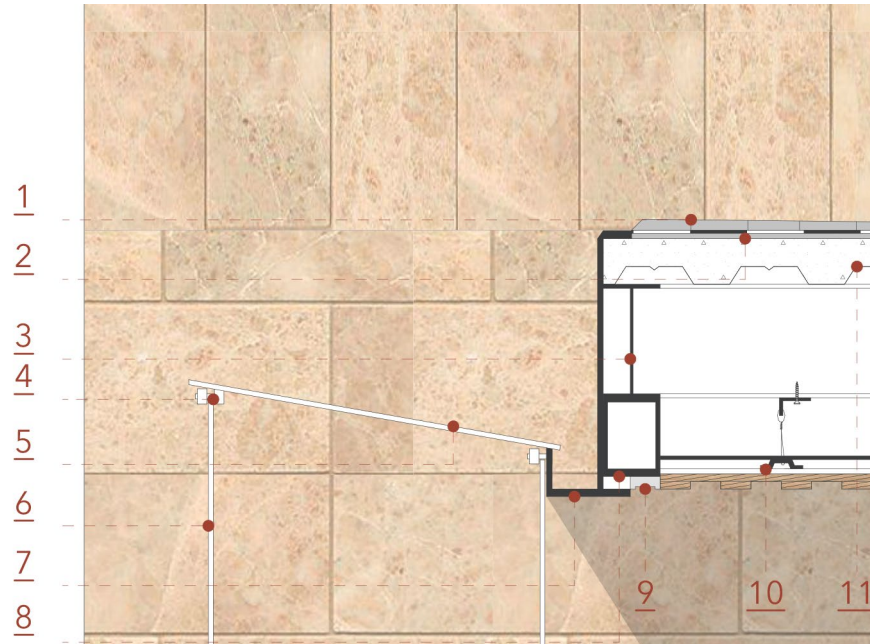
Detalle constructivo de remate superior en fachada de vidrio. Gráficos de la autora.
